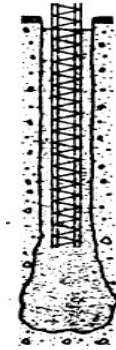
Pondasi tiang pancang (*spun pile*)
